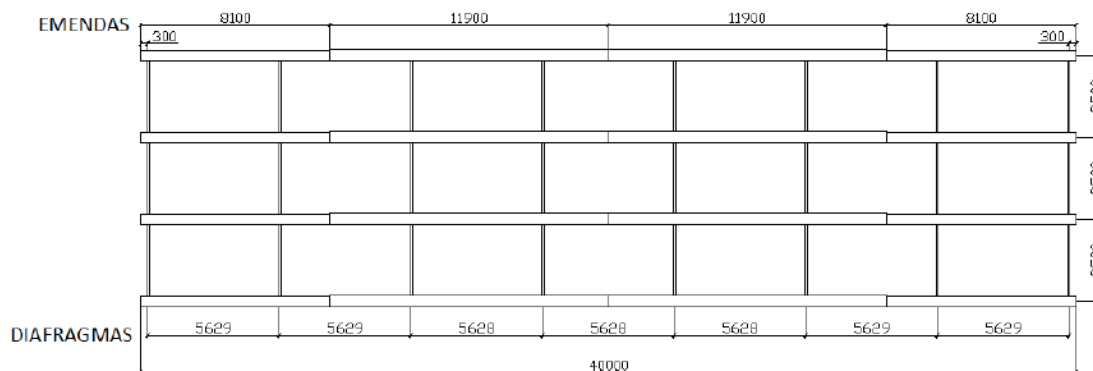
Vista da ponte em planta (mm) (TOLEDO, 2011)
